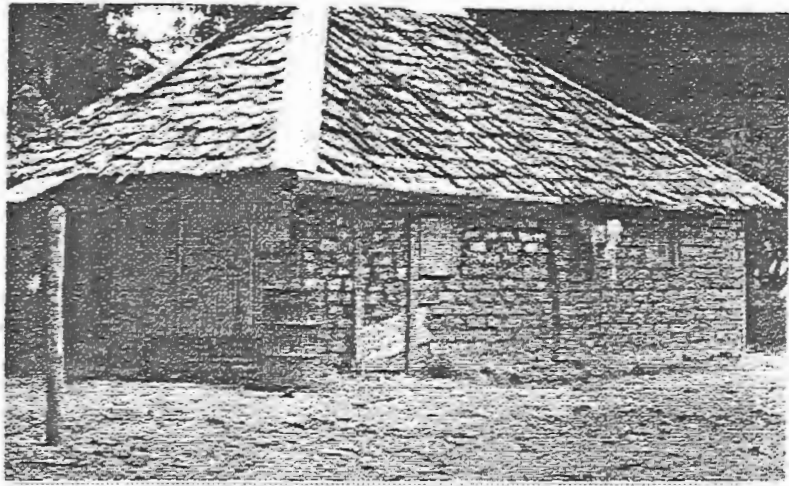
Habitação em adobe e telha de madeira (cavaco).
